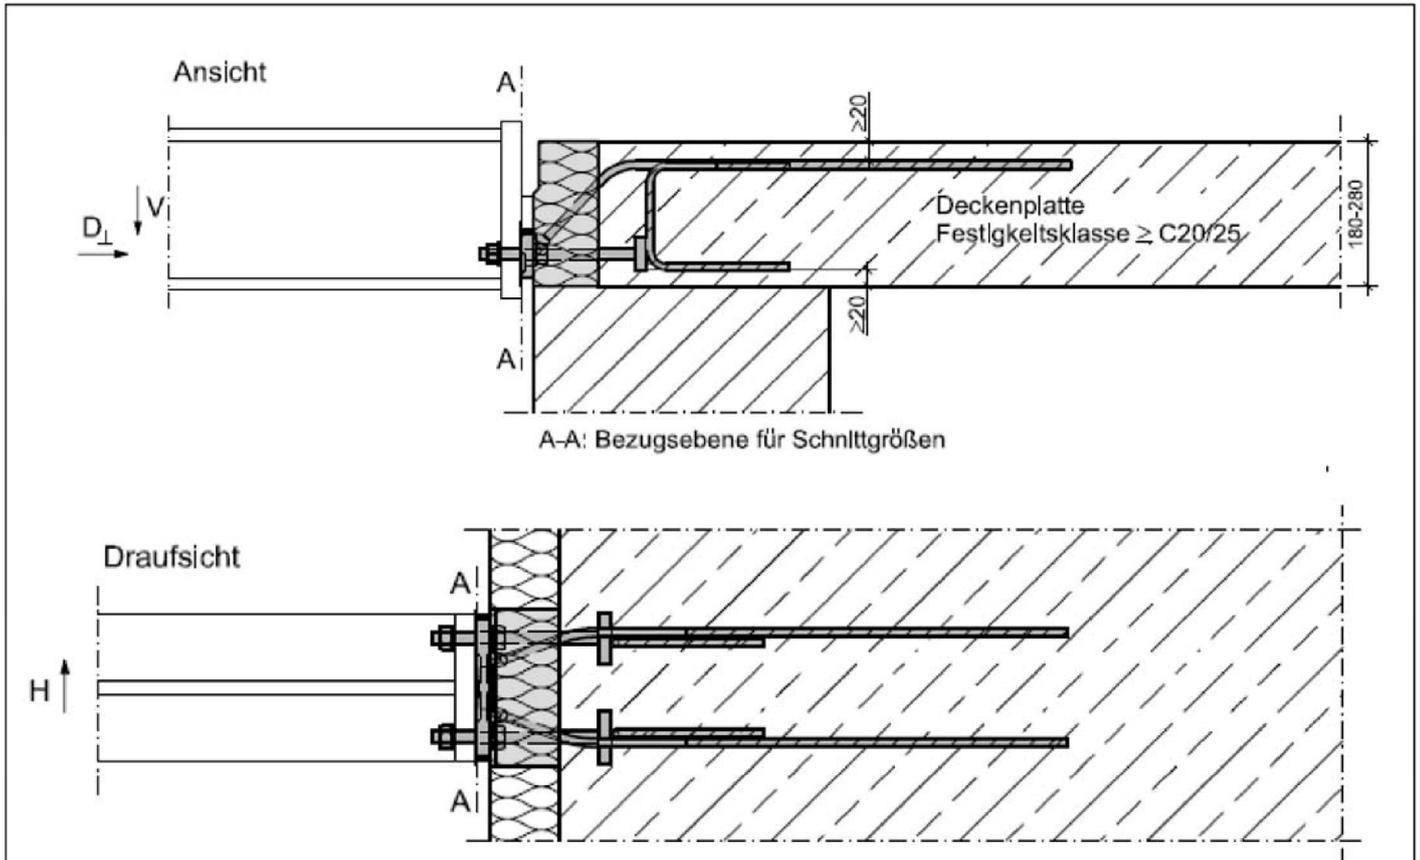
und 62: Schöck Isokorb® T Typ SQ-V1, T Typ SQ-V2 und T Typ SQ-V3, Schnittgrößendefinition
